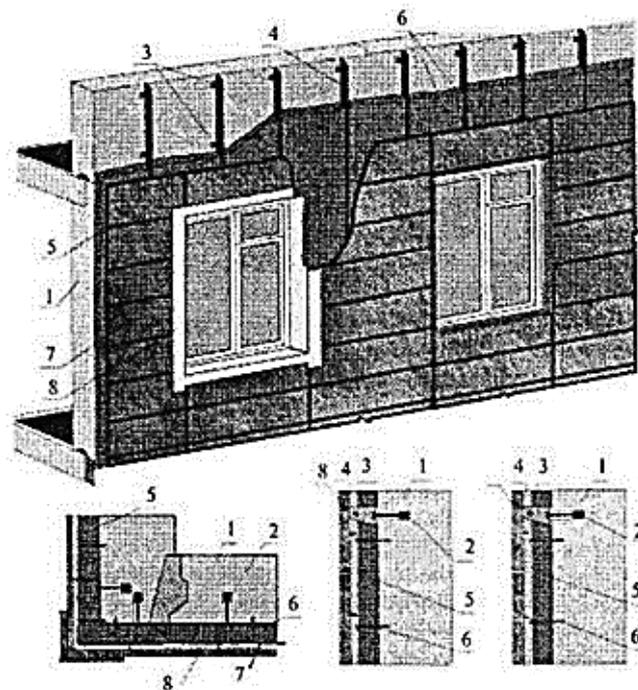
Конструктивные технологические схемы утепления и облицовки фасадов армоцементными плитами: 1 — стеновая панель; 2 — распорный анкер; 3 — кронштейн; 4 — вентилируемый зазор; 5 — утеплитель; 6 — направляющая; 7 — облицовочная панель; 8 — объемный элемент оконного обрамления.
